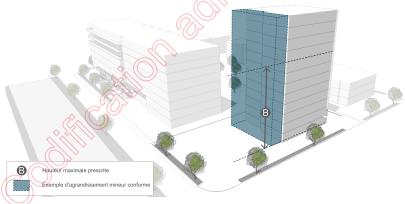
Agrandissement mineur d'une construction dérogatoire à la hauteur maximale
